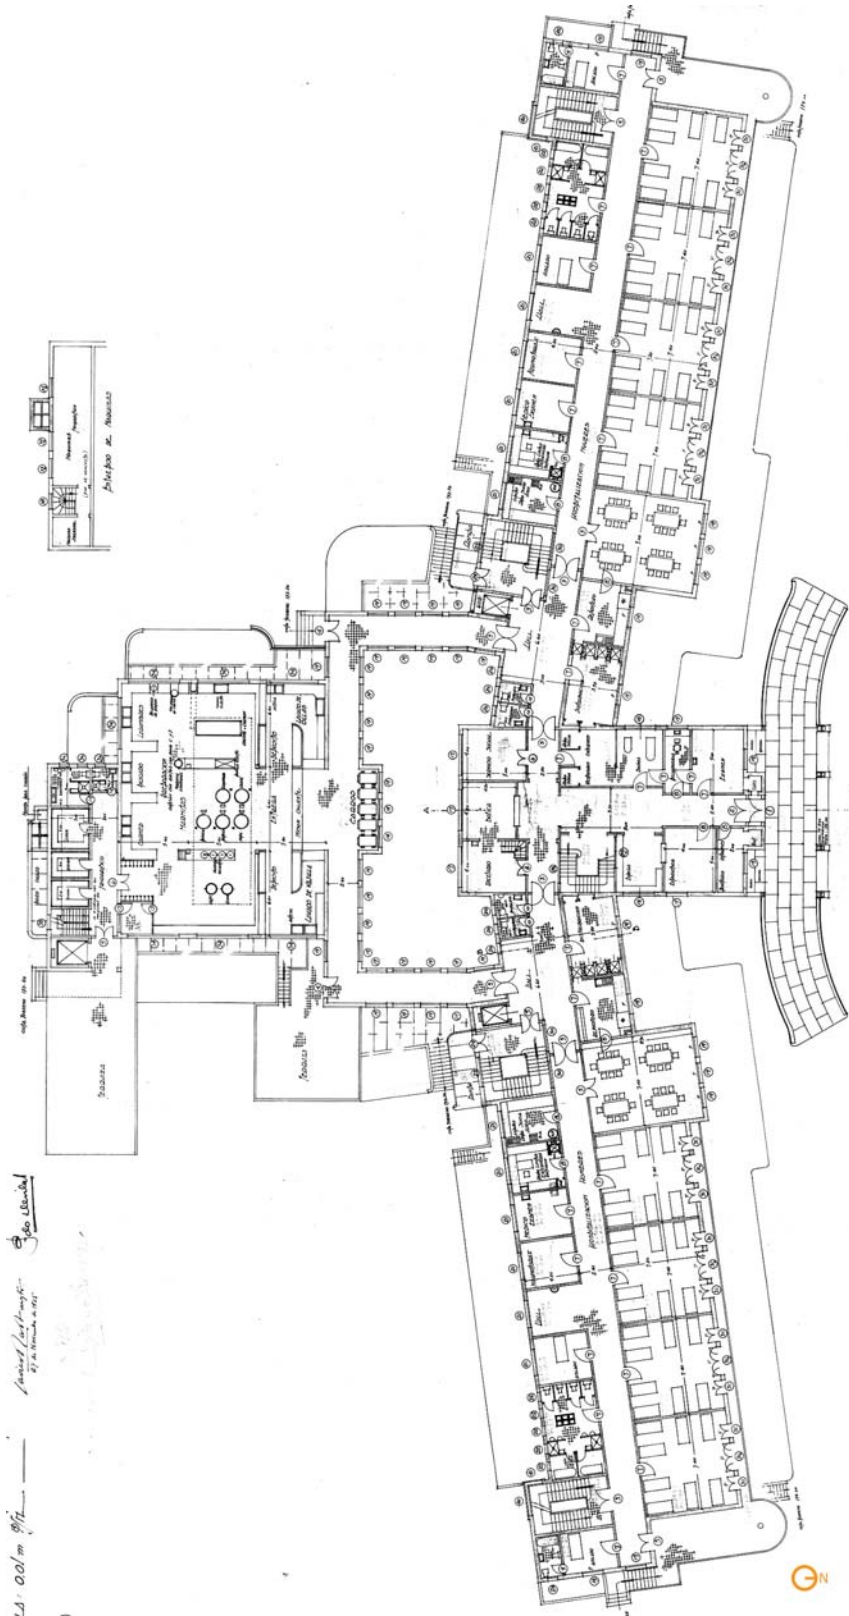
Planta del primer piso. Fuente: escaneo de la planimetría del proyecto original de 1935. Toda la planimetría proviene de la misma fuente. Las intervenciones en color son del autor
